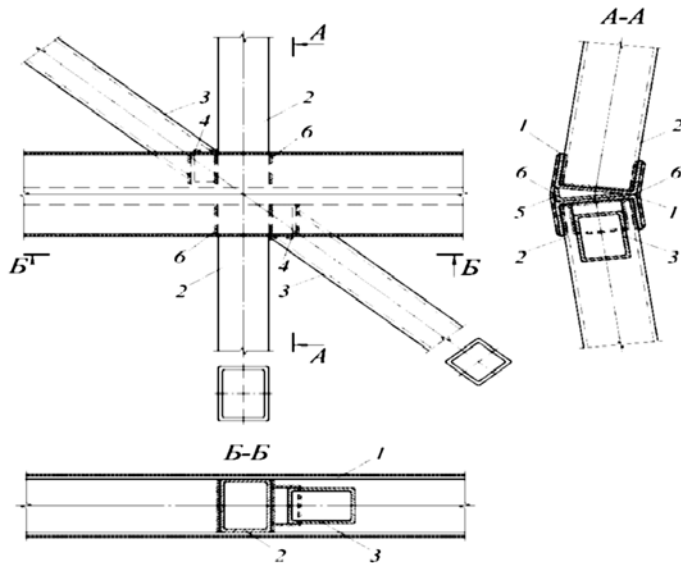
Узловое соединение для крупноблочной сборки металлической цилиндрической сетчатой оболочки:
